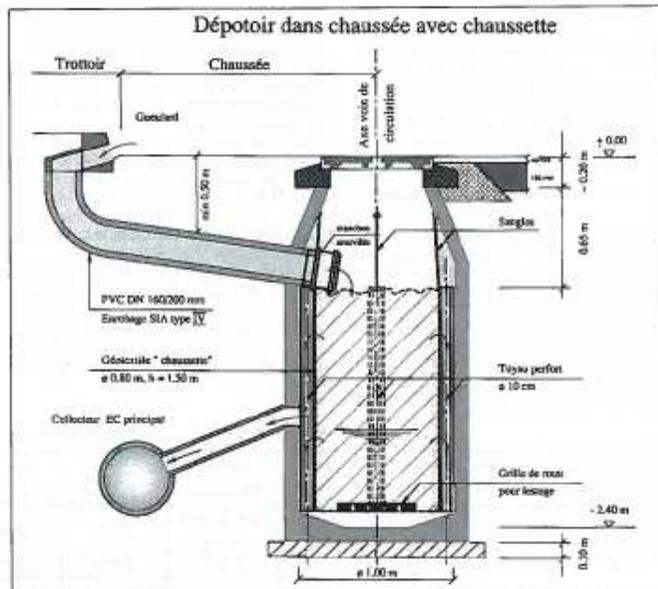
Coupe sur le système avec chaussettes mis en place le 16 octobre 2007.
